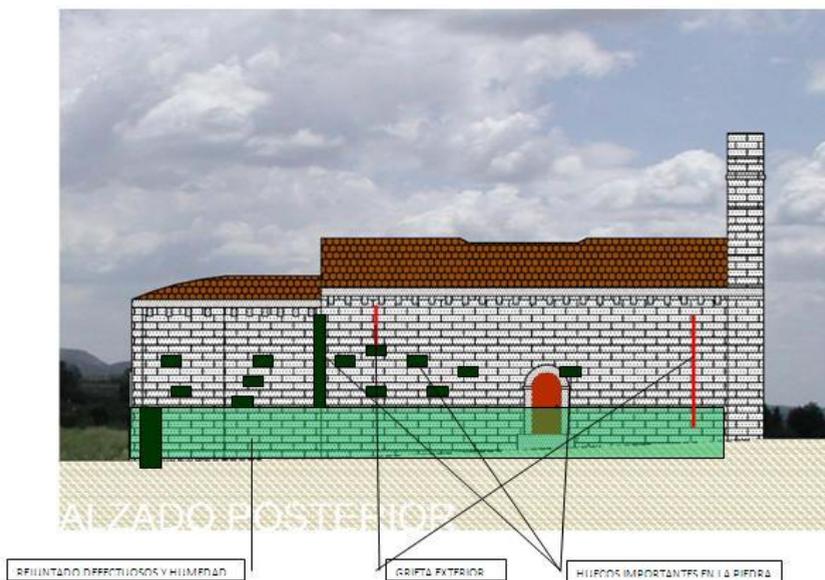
Manifestaciones patológicas en alzado posterior. Año 2009. Fuente: elaboración propia
